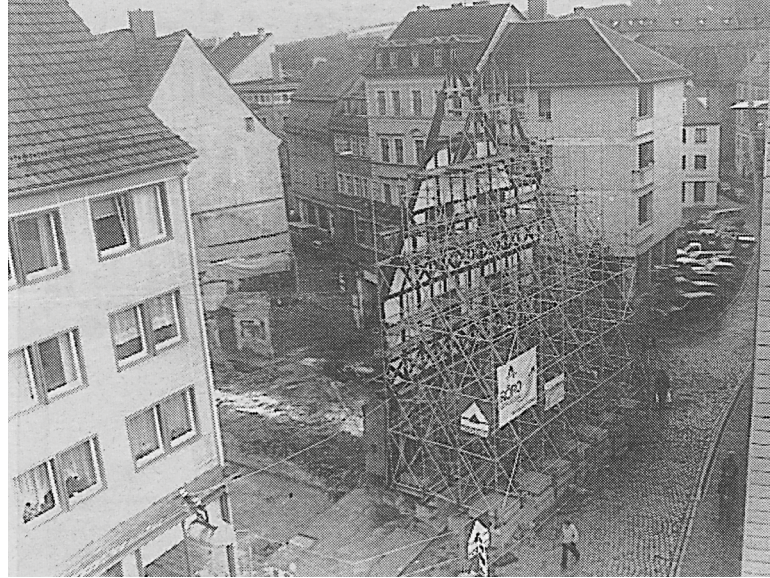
Abgestützte Fachwerkfassaden des Löschhauses, Ecke Schloßgasse/Marktstraße, F.B.: „Das Löschhaus zu Weimar vereint früher mit heute“ Stadtanzeiger Weimar, 05.06.1997.
